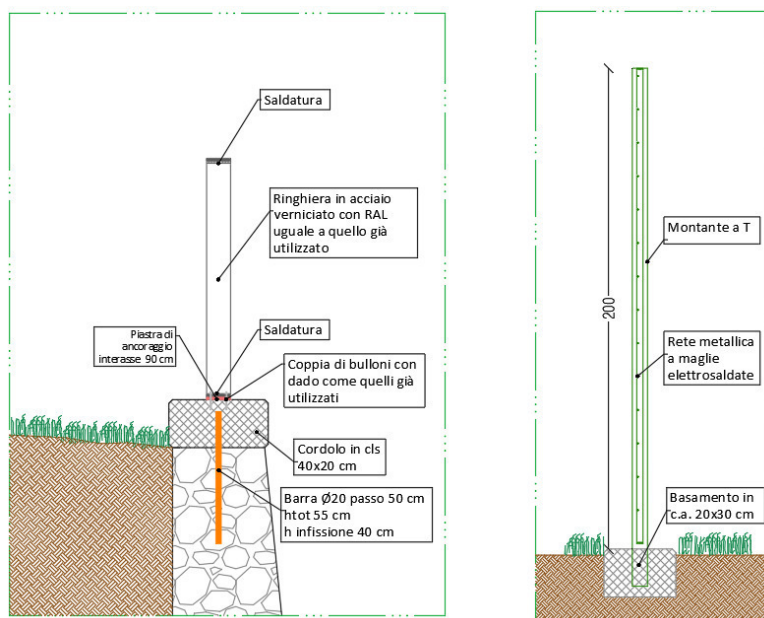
particolari costruttivi, a sinistra del parapetto a destra della recinzione.
